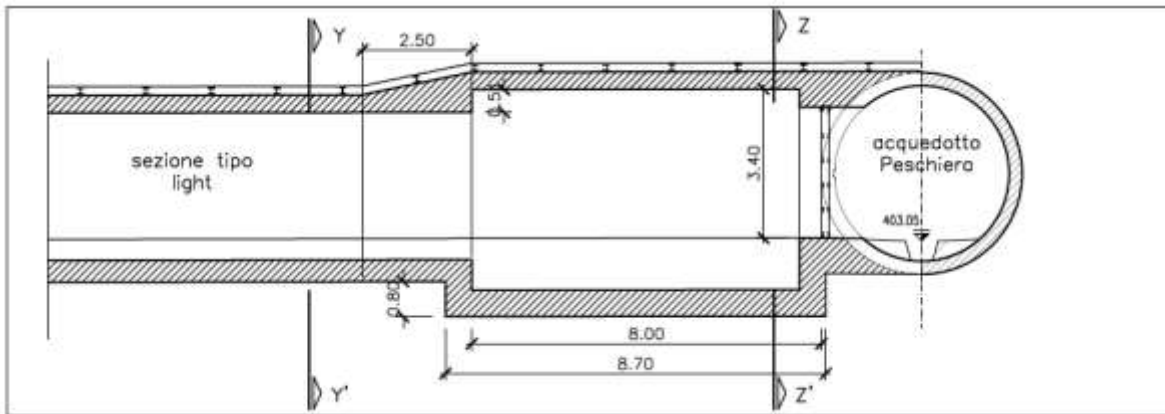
Sezione e dettaglio dell’attacco alla galleria Ponzano
